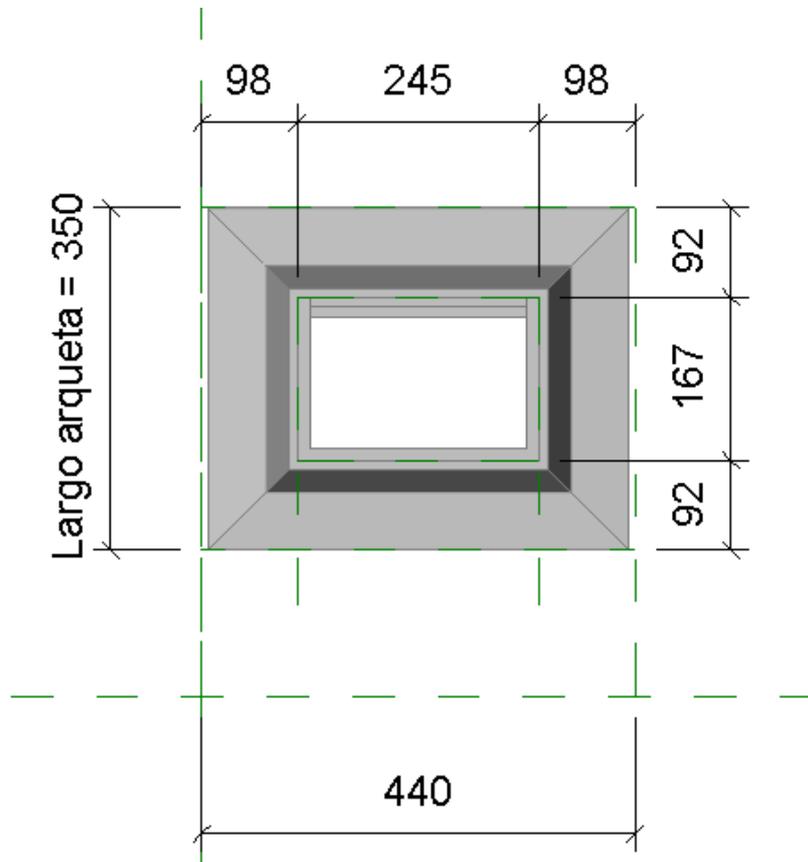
Restricciones geométricas de la arqueta en planta.
